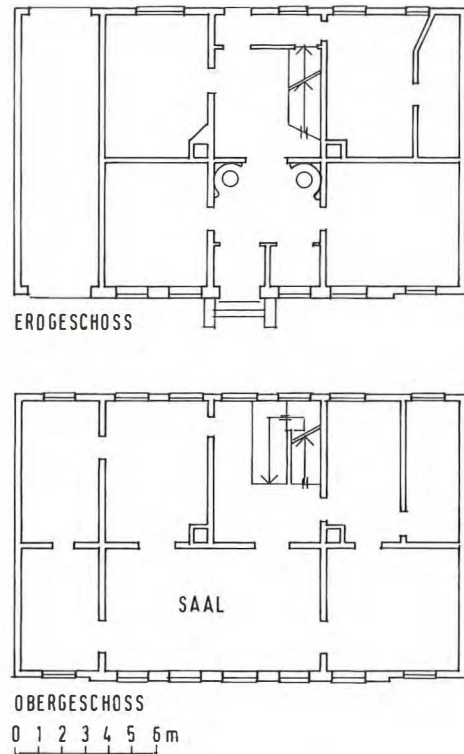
Grundriss Erdgeschoss und Obergeschoss.
